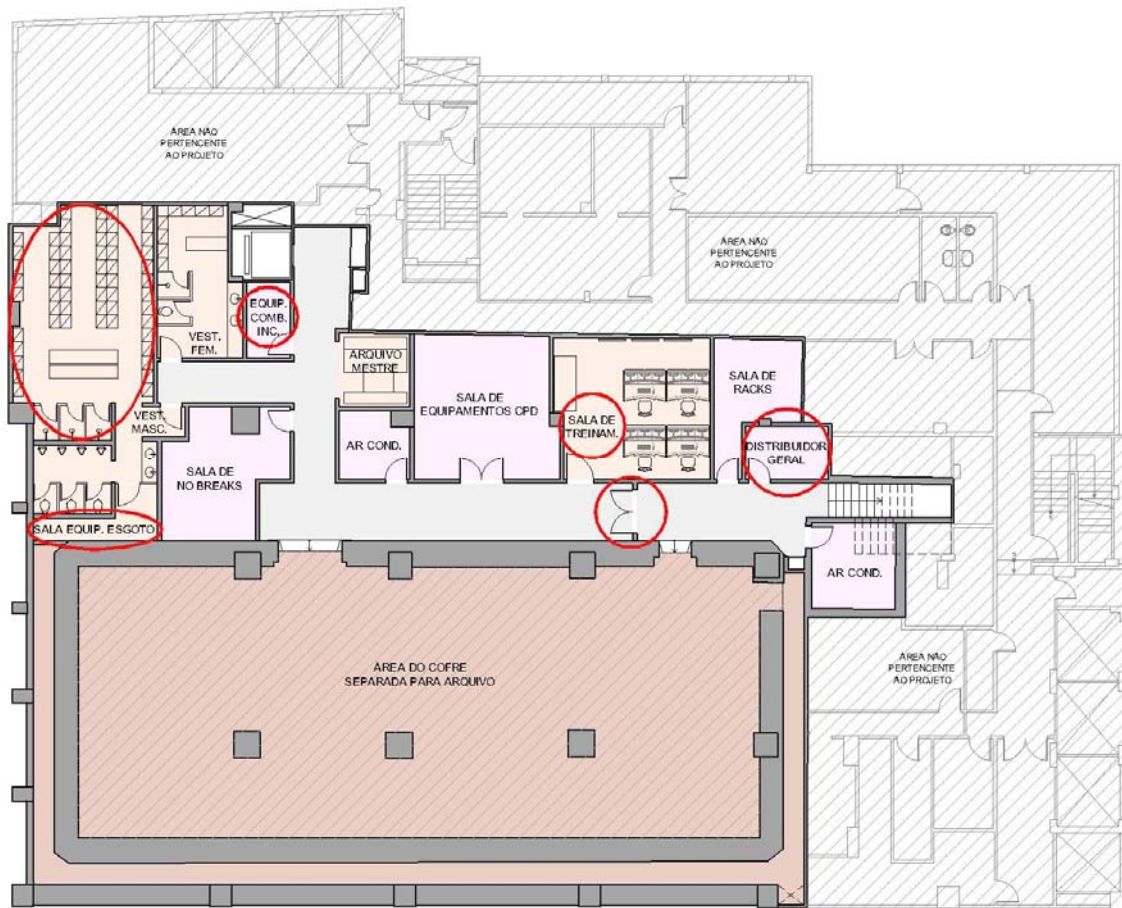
Planta baixa subsolo: alterações do layout (vinte de junho)
